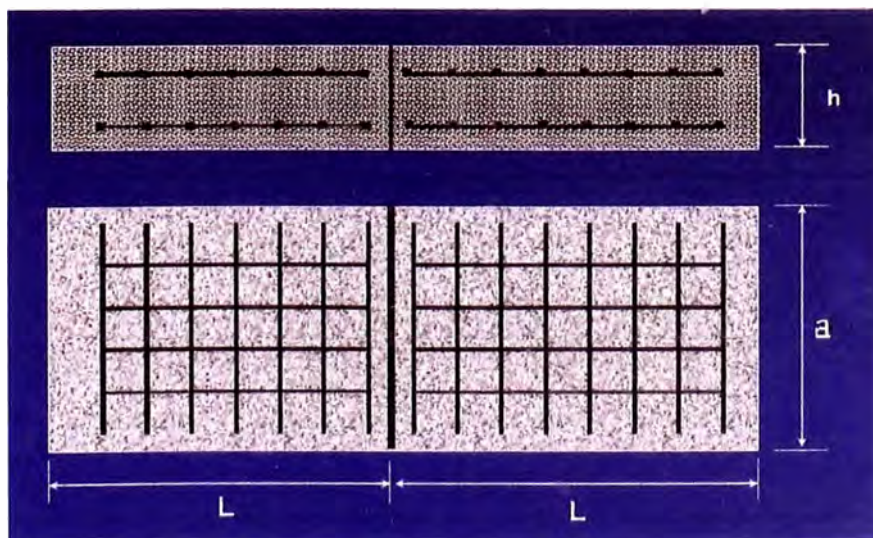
Vigas de concreto armado (PCCR) en la misma elevación para grúas RTG.
